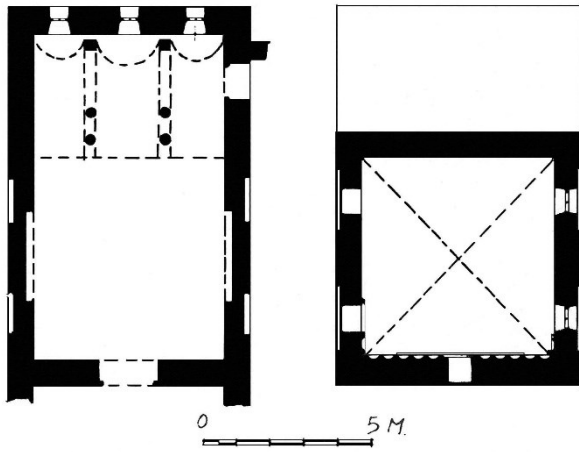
Grundriss von Santa Maria in Valle in Cividale
